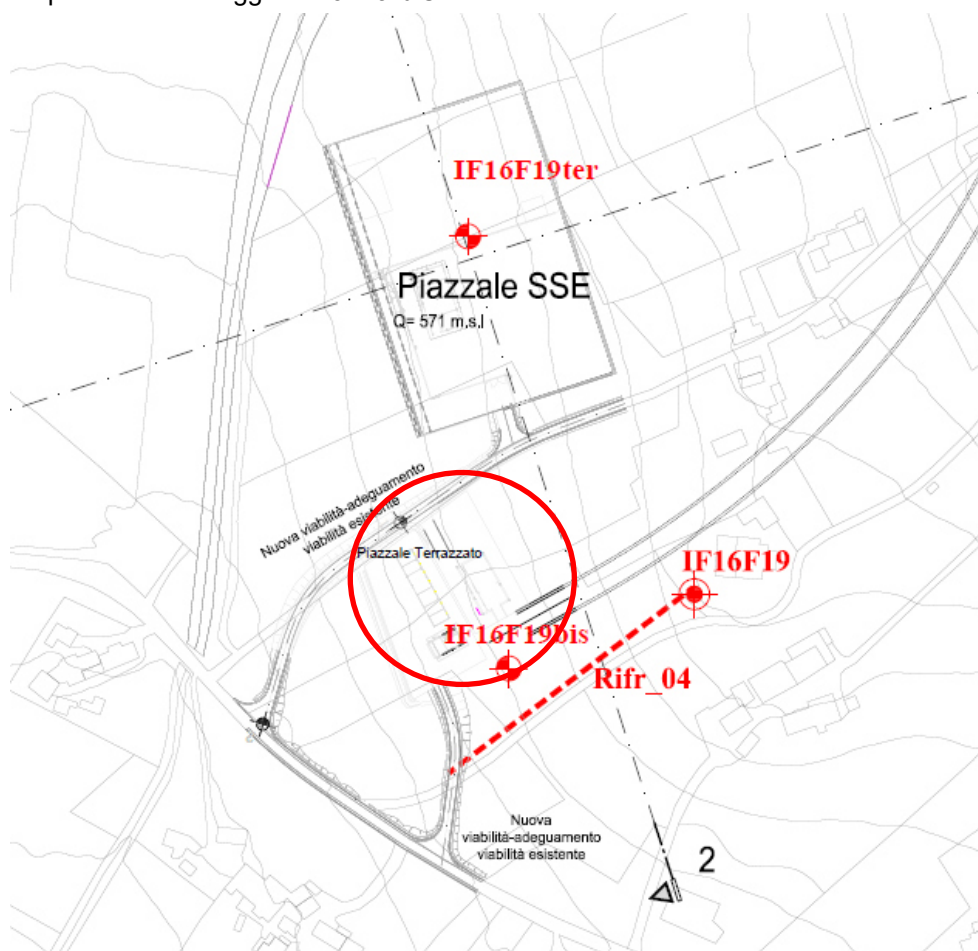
Planimetria di ubicazione dei sondaggi e posizione del piazzale
